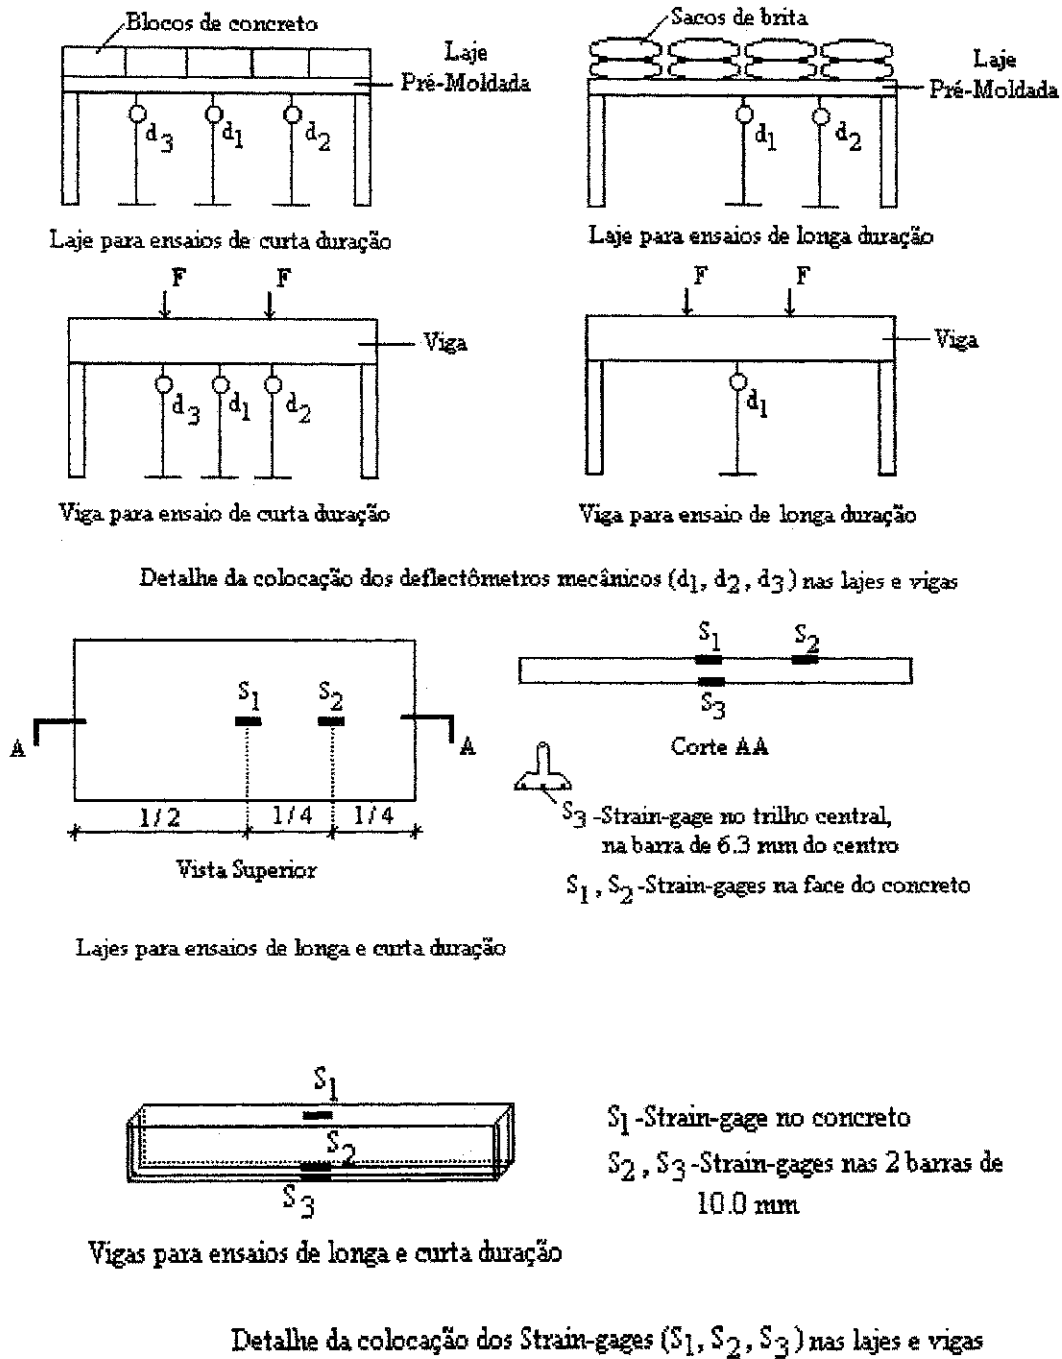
Disposição dos Instrumentos de Medição nas Lajes e Vigas Ensaaiadas
